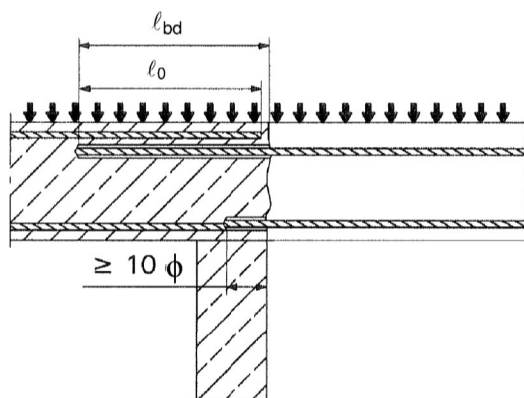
Joint de recouvrement au niveau d'une fondation d'un mur ou d'une colonne où les barres d'armature sont sollicitées en tension
